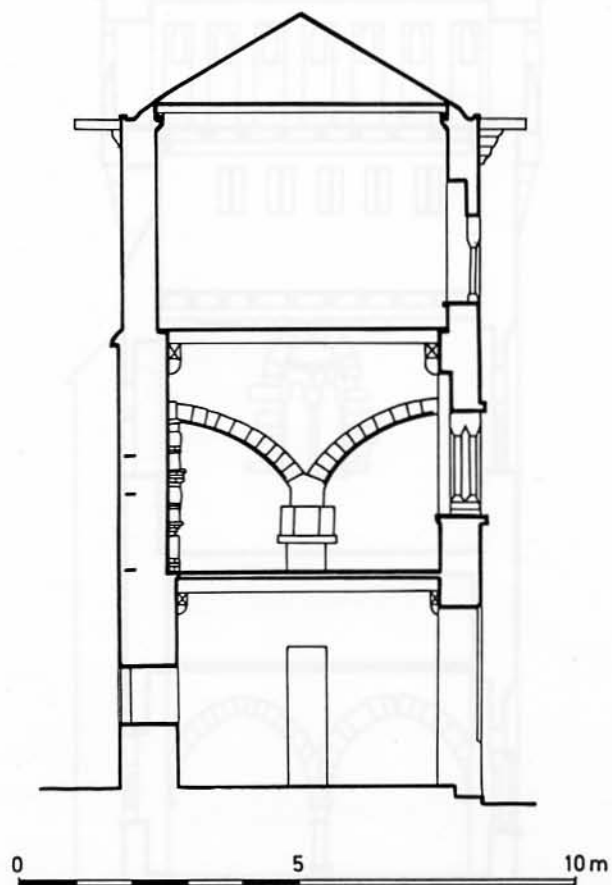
COUPE TRANSVERSALE DU CORPS DE BATIMENT PRINCIPAL ET ELEVATION INTERIEURE DU MUR NORD (Relevé P. Roques, Inventaire Général); a : vestiges de la porte primitive.
